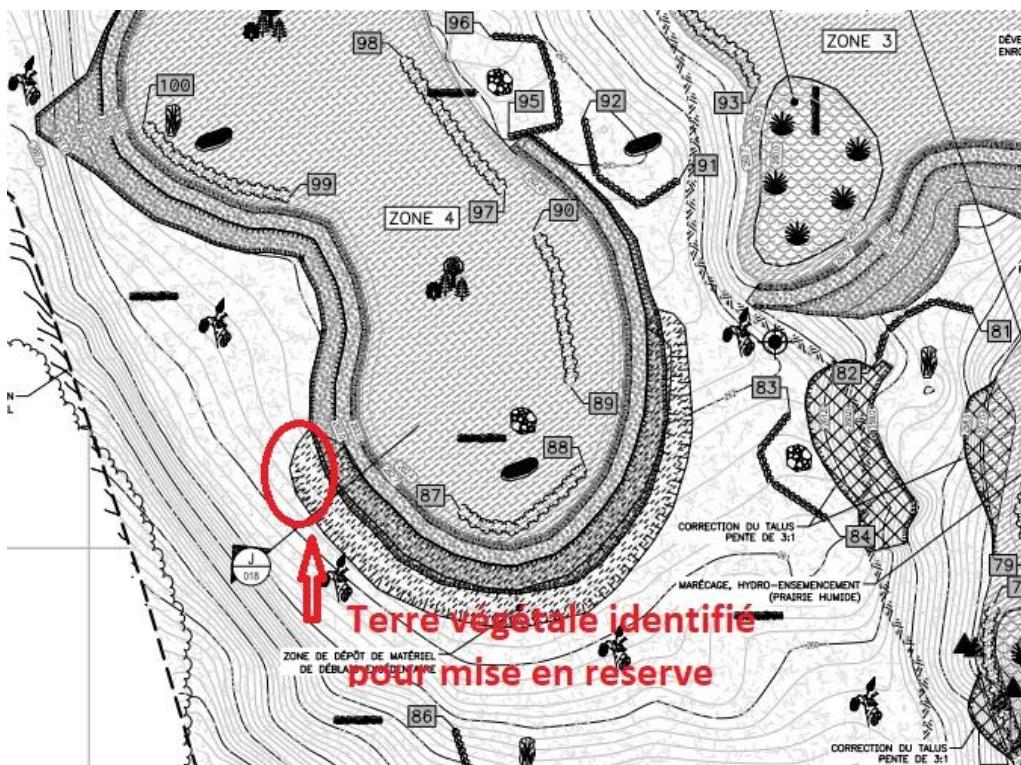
Till (08-06-2022) : Secteur Ouest de la zone 4 (plan : 6733-7080-0017)
